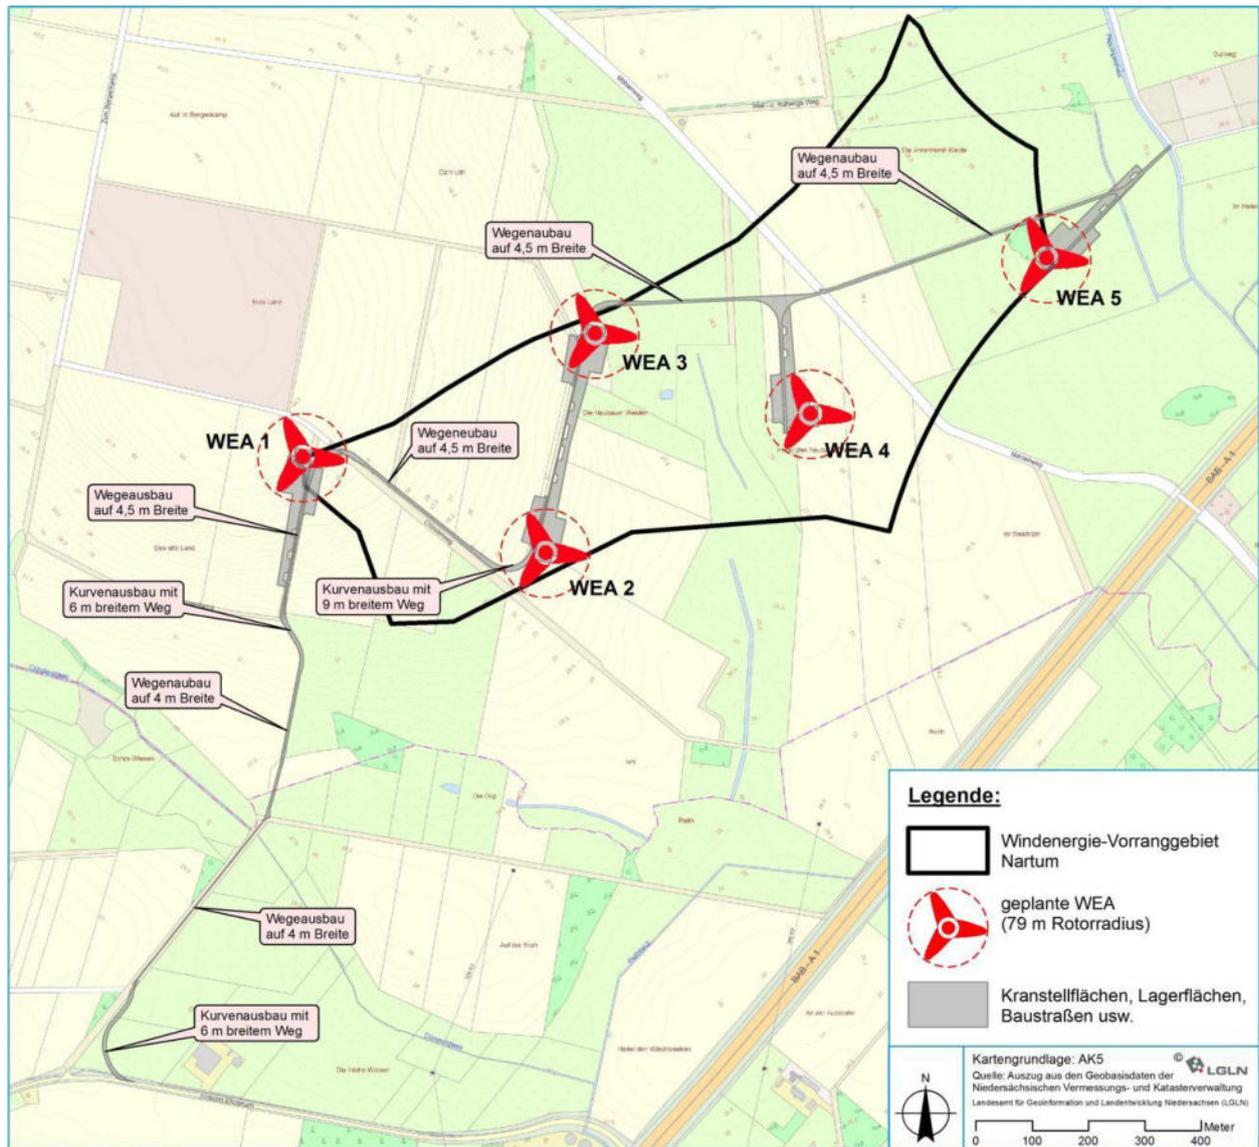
Lageplan der vorgesehenen WEA mit Kennzeichnung der damit verbundenen Flächenbeanspruchungen (Quelle: EnergieKontor AG)
